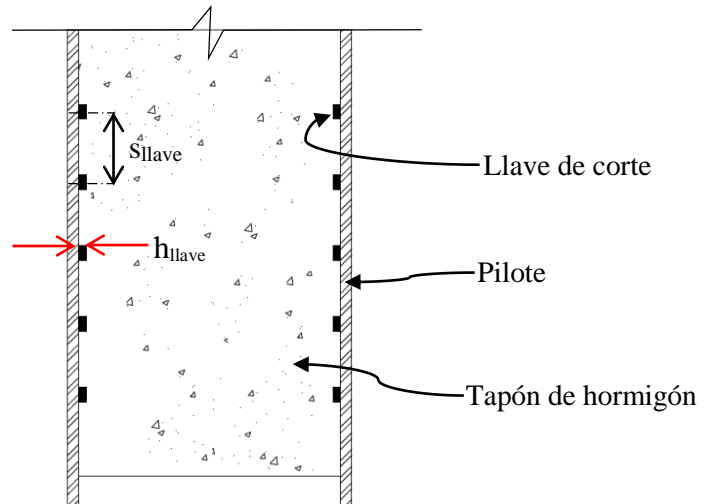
Parámetros de diseño para las llaves de corte (armadura de refuerzo y barras de anclaje no se muestran).
